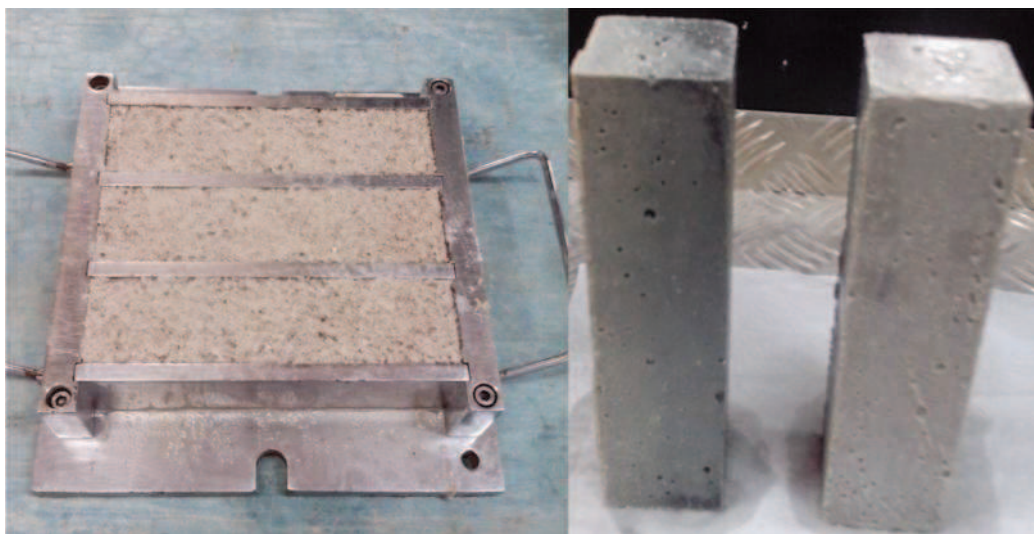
A) Moldes prismáticos. B) Corpos de prova. Fonte: Pessoal.
